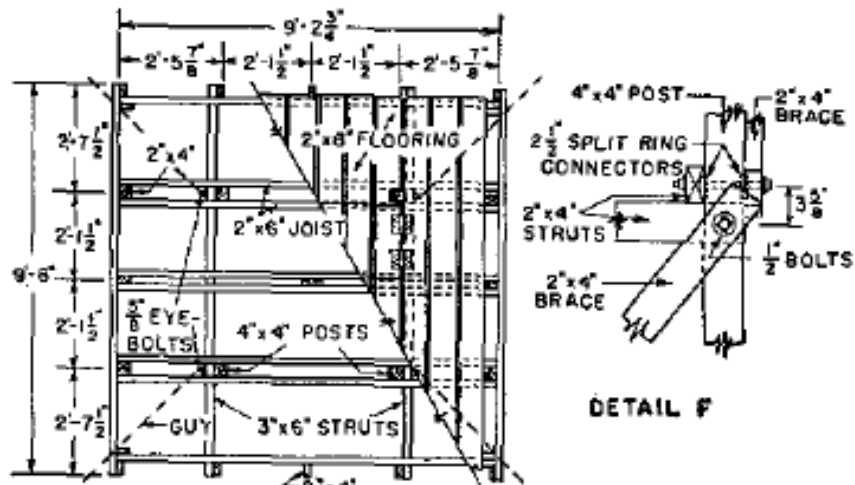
Věž pro zaměřovač – pohled, konstrukční detaily
